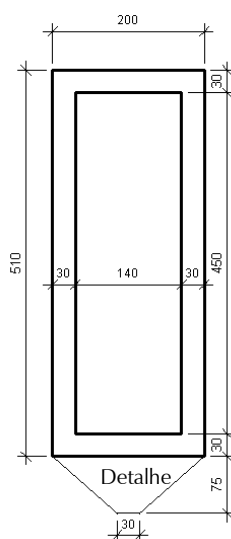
Vista em planta do Aqueduto Mão Direita
